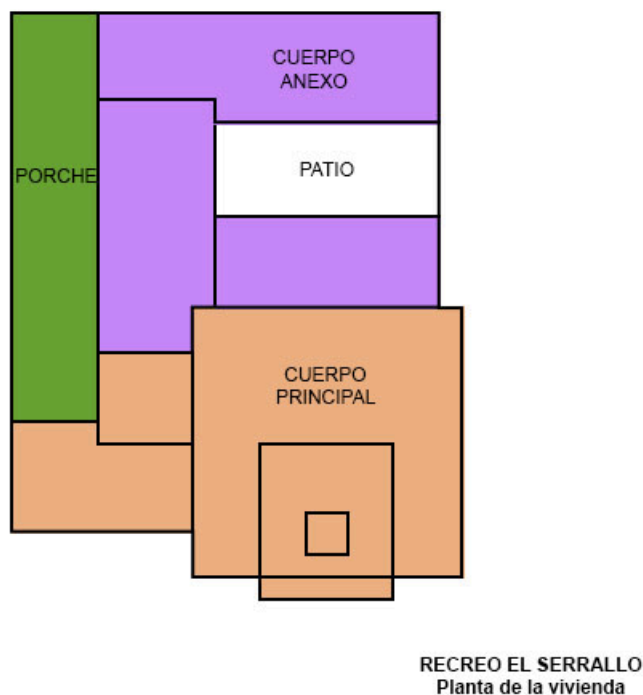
Planta de El Serrallo. Fuente: Elaboración propia.
